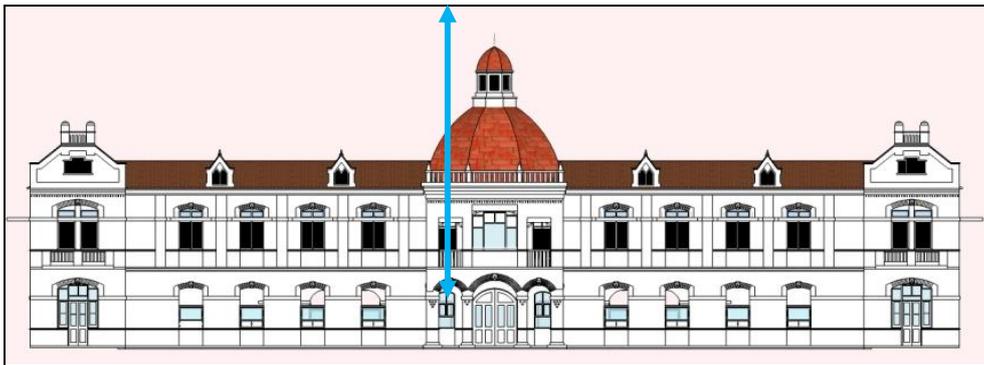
Massa bangunan restoran 'Halo Surabaya'
